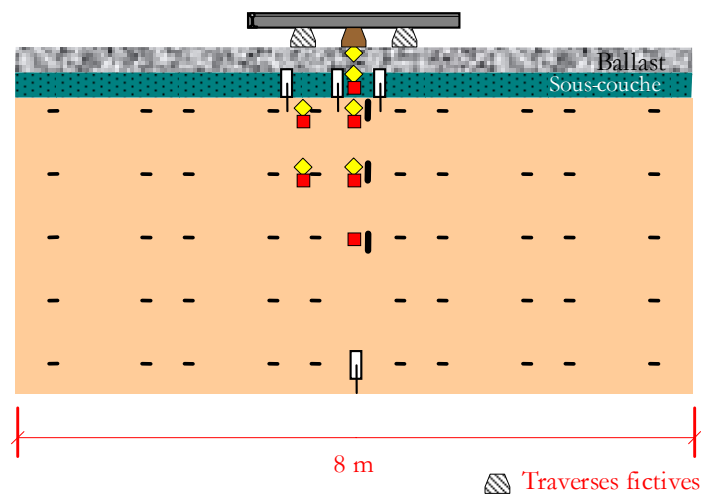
Plan d'instrumentation : Coupe transversale (d'après Froumentin et al., 2008).
